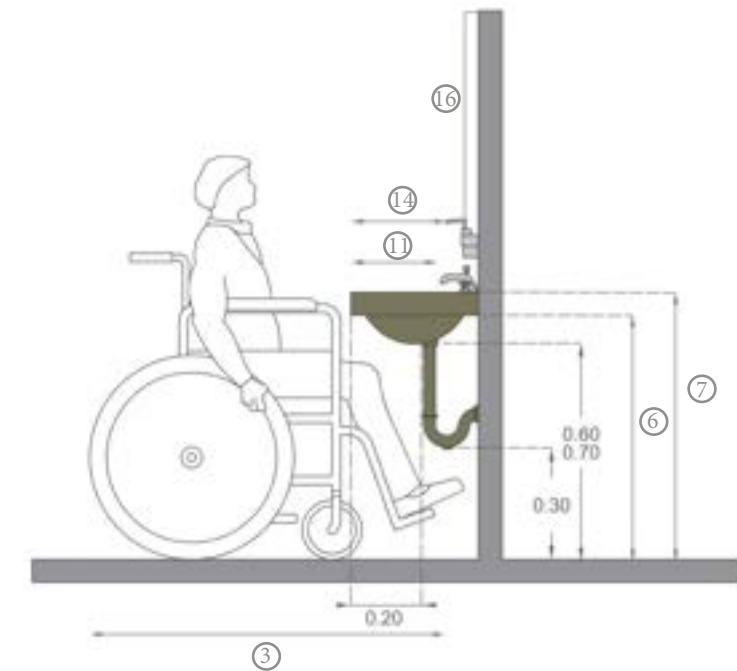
2 Altura y espacio libre inferior de lavabó - Alzado
